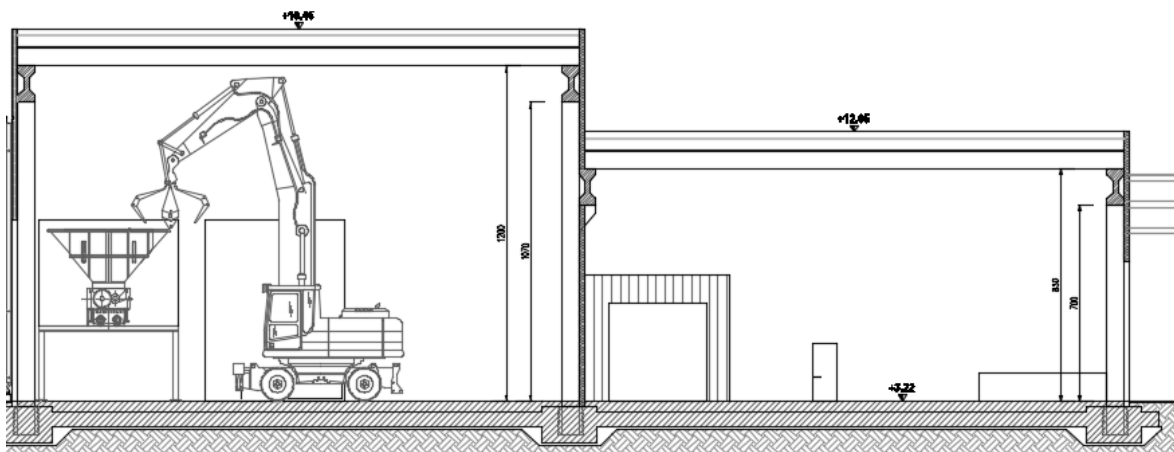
sezione trasversale capannone lavorazione solidi (N1-N2)
